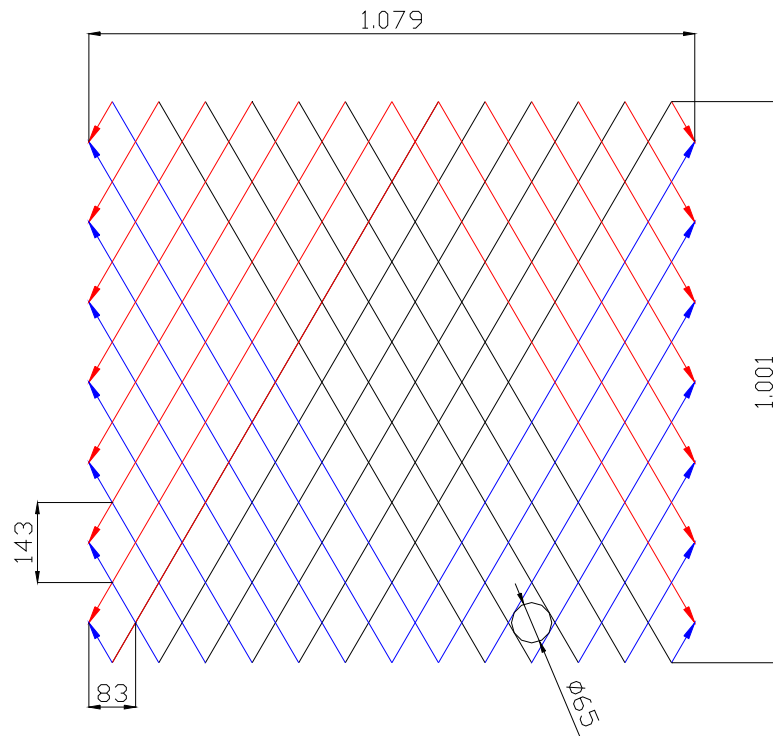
Muestra para ensayo de tracción directa longitudinal
